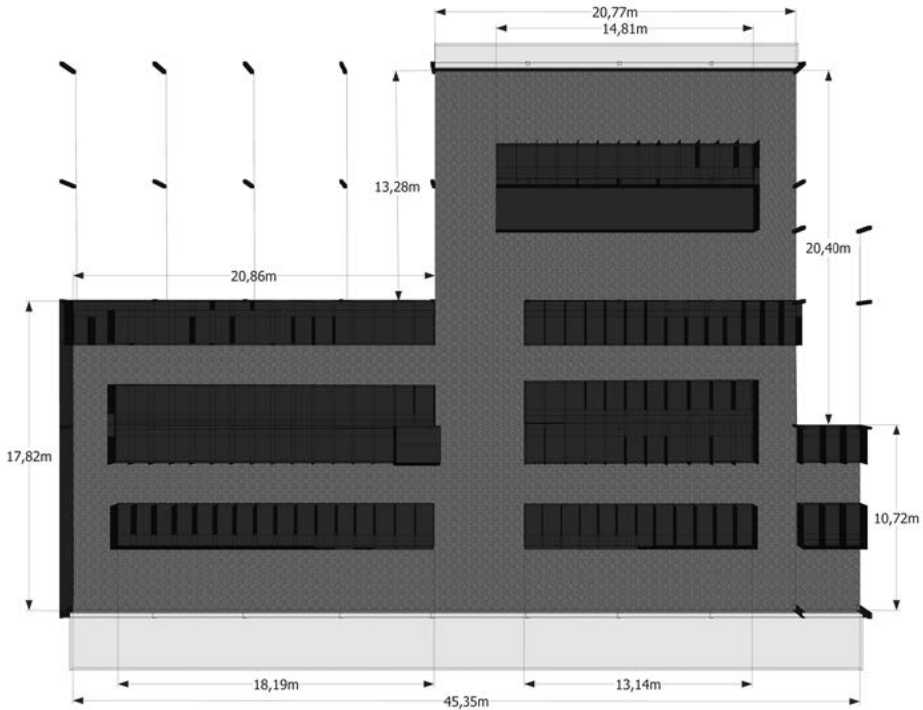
Grundriss des Versuchsstalls (Erfassungsbereich grau hinterlegt)
